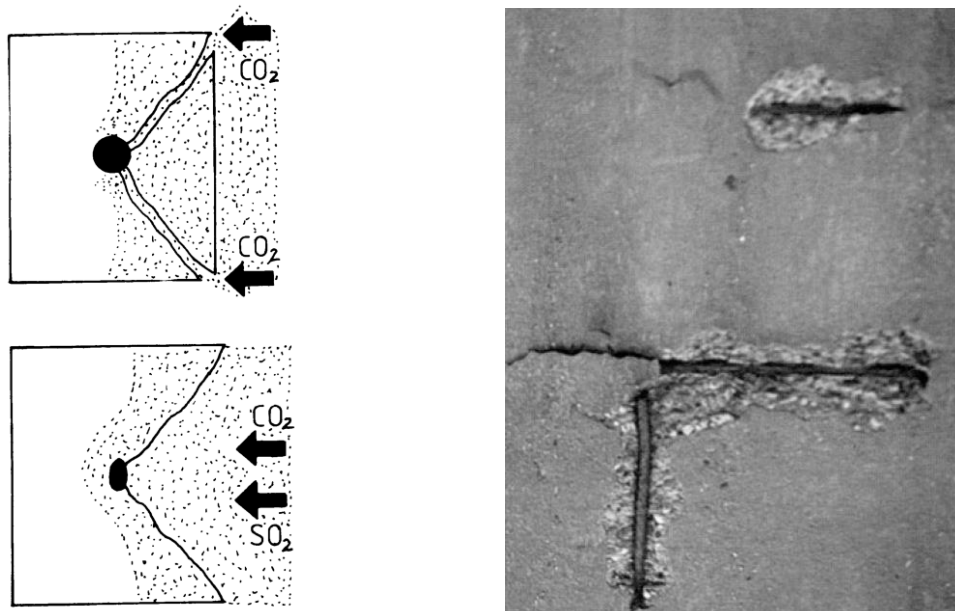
Links – Prozesse der Betonzerstörung; Rechts – Absprengungen an einer Betonoberfläche (Stahr, 2011)
